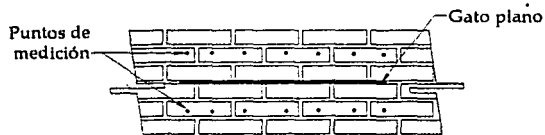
Determinación in situ del estado de esfuerzos de compresión existente dentro de la mampostería.
